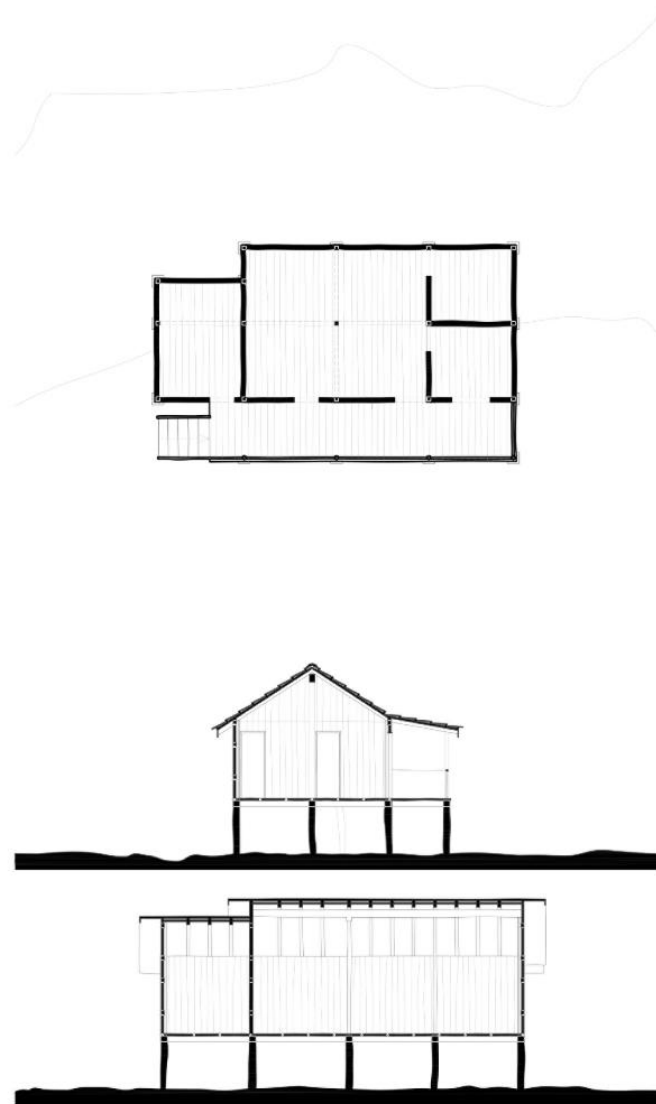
Casa avieira: planta, secção longitudinal e transversal.
